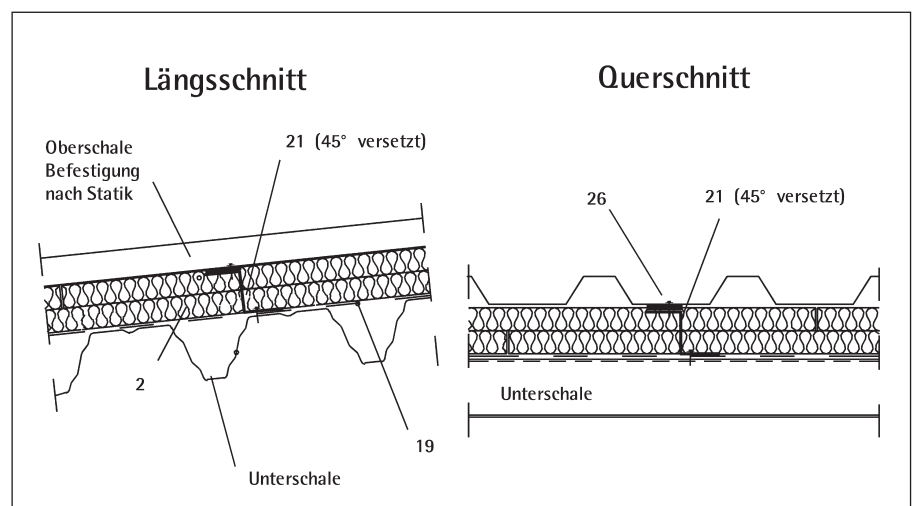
Zweischalige Dachkonstruktion: Regelaufbau verschiedener Systeme
